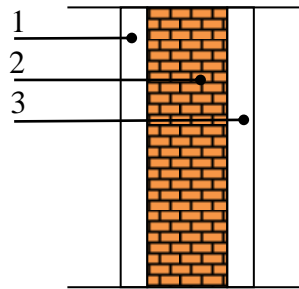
Coupe horizontale d'un mur de séparation.
